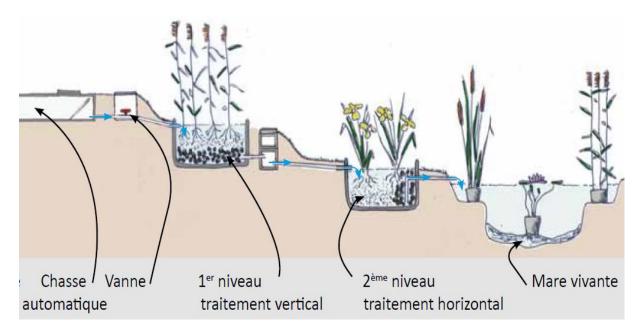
Coupe schématique de filtres plantés verticaux et horizontaux (Source [6])
